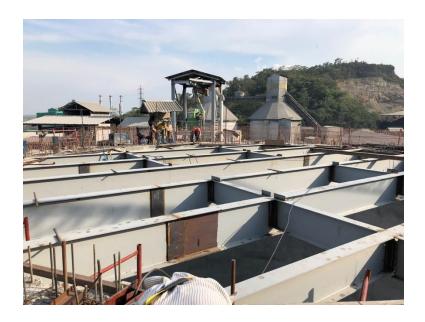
Colocación de vigas H nivel 36.00 msnm silo 14.
